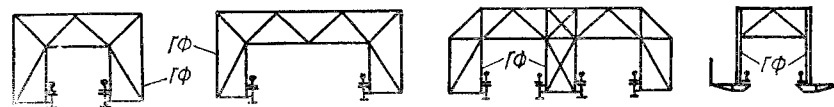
Схемы поперечных рам (ГФ — главная ферма)
